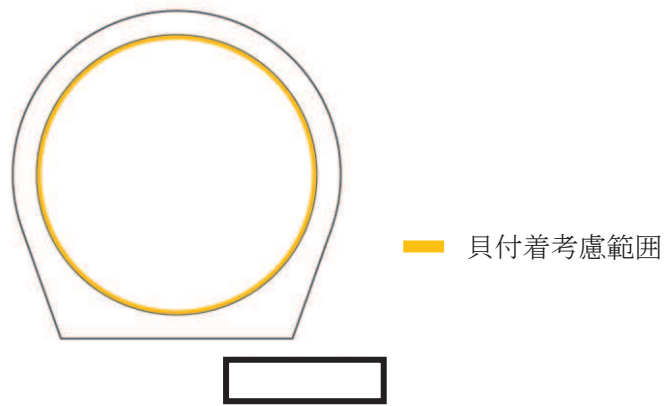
(6) 第 3 号機放水路 ③' -③' 断面図
